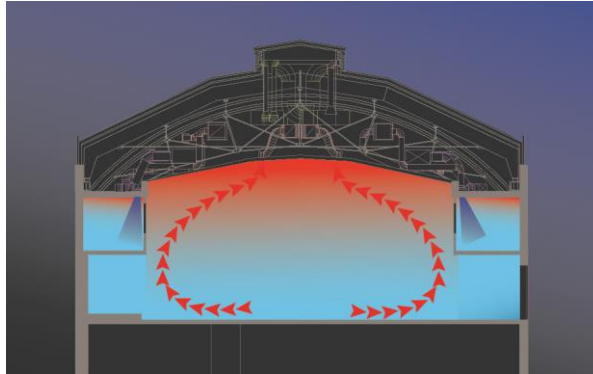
Detalle de caudal variable PLANTA BAJA
